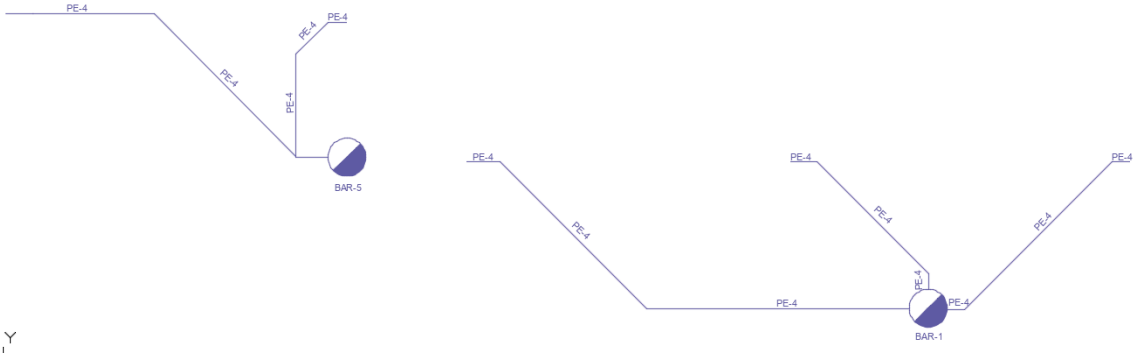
Red de PE consultas zona norte de primera y segunda planta.
